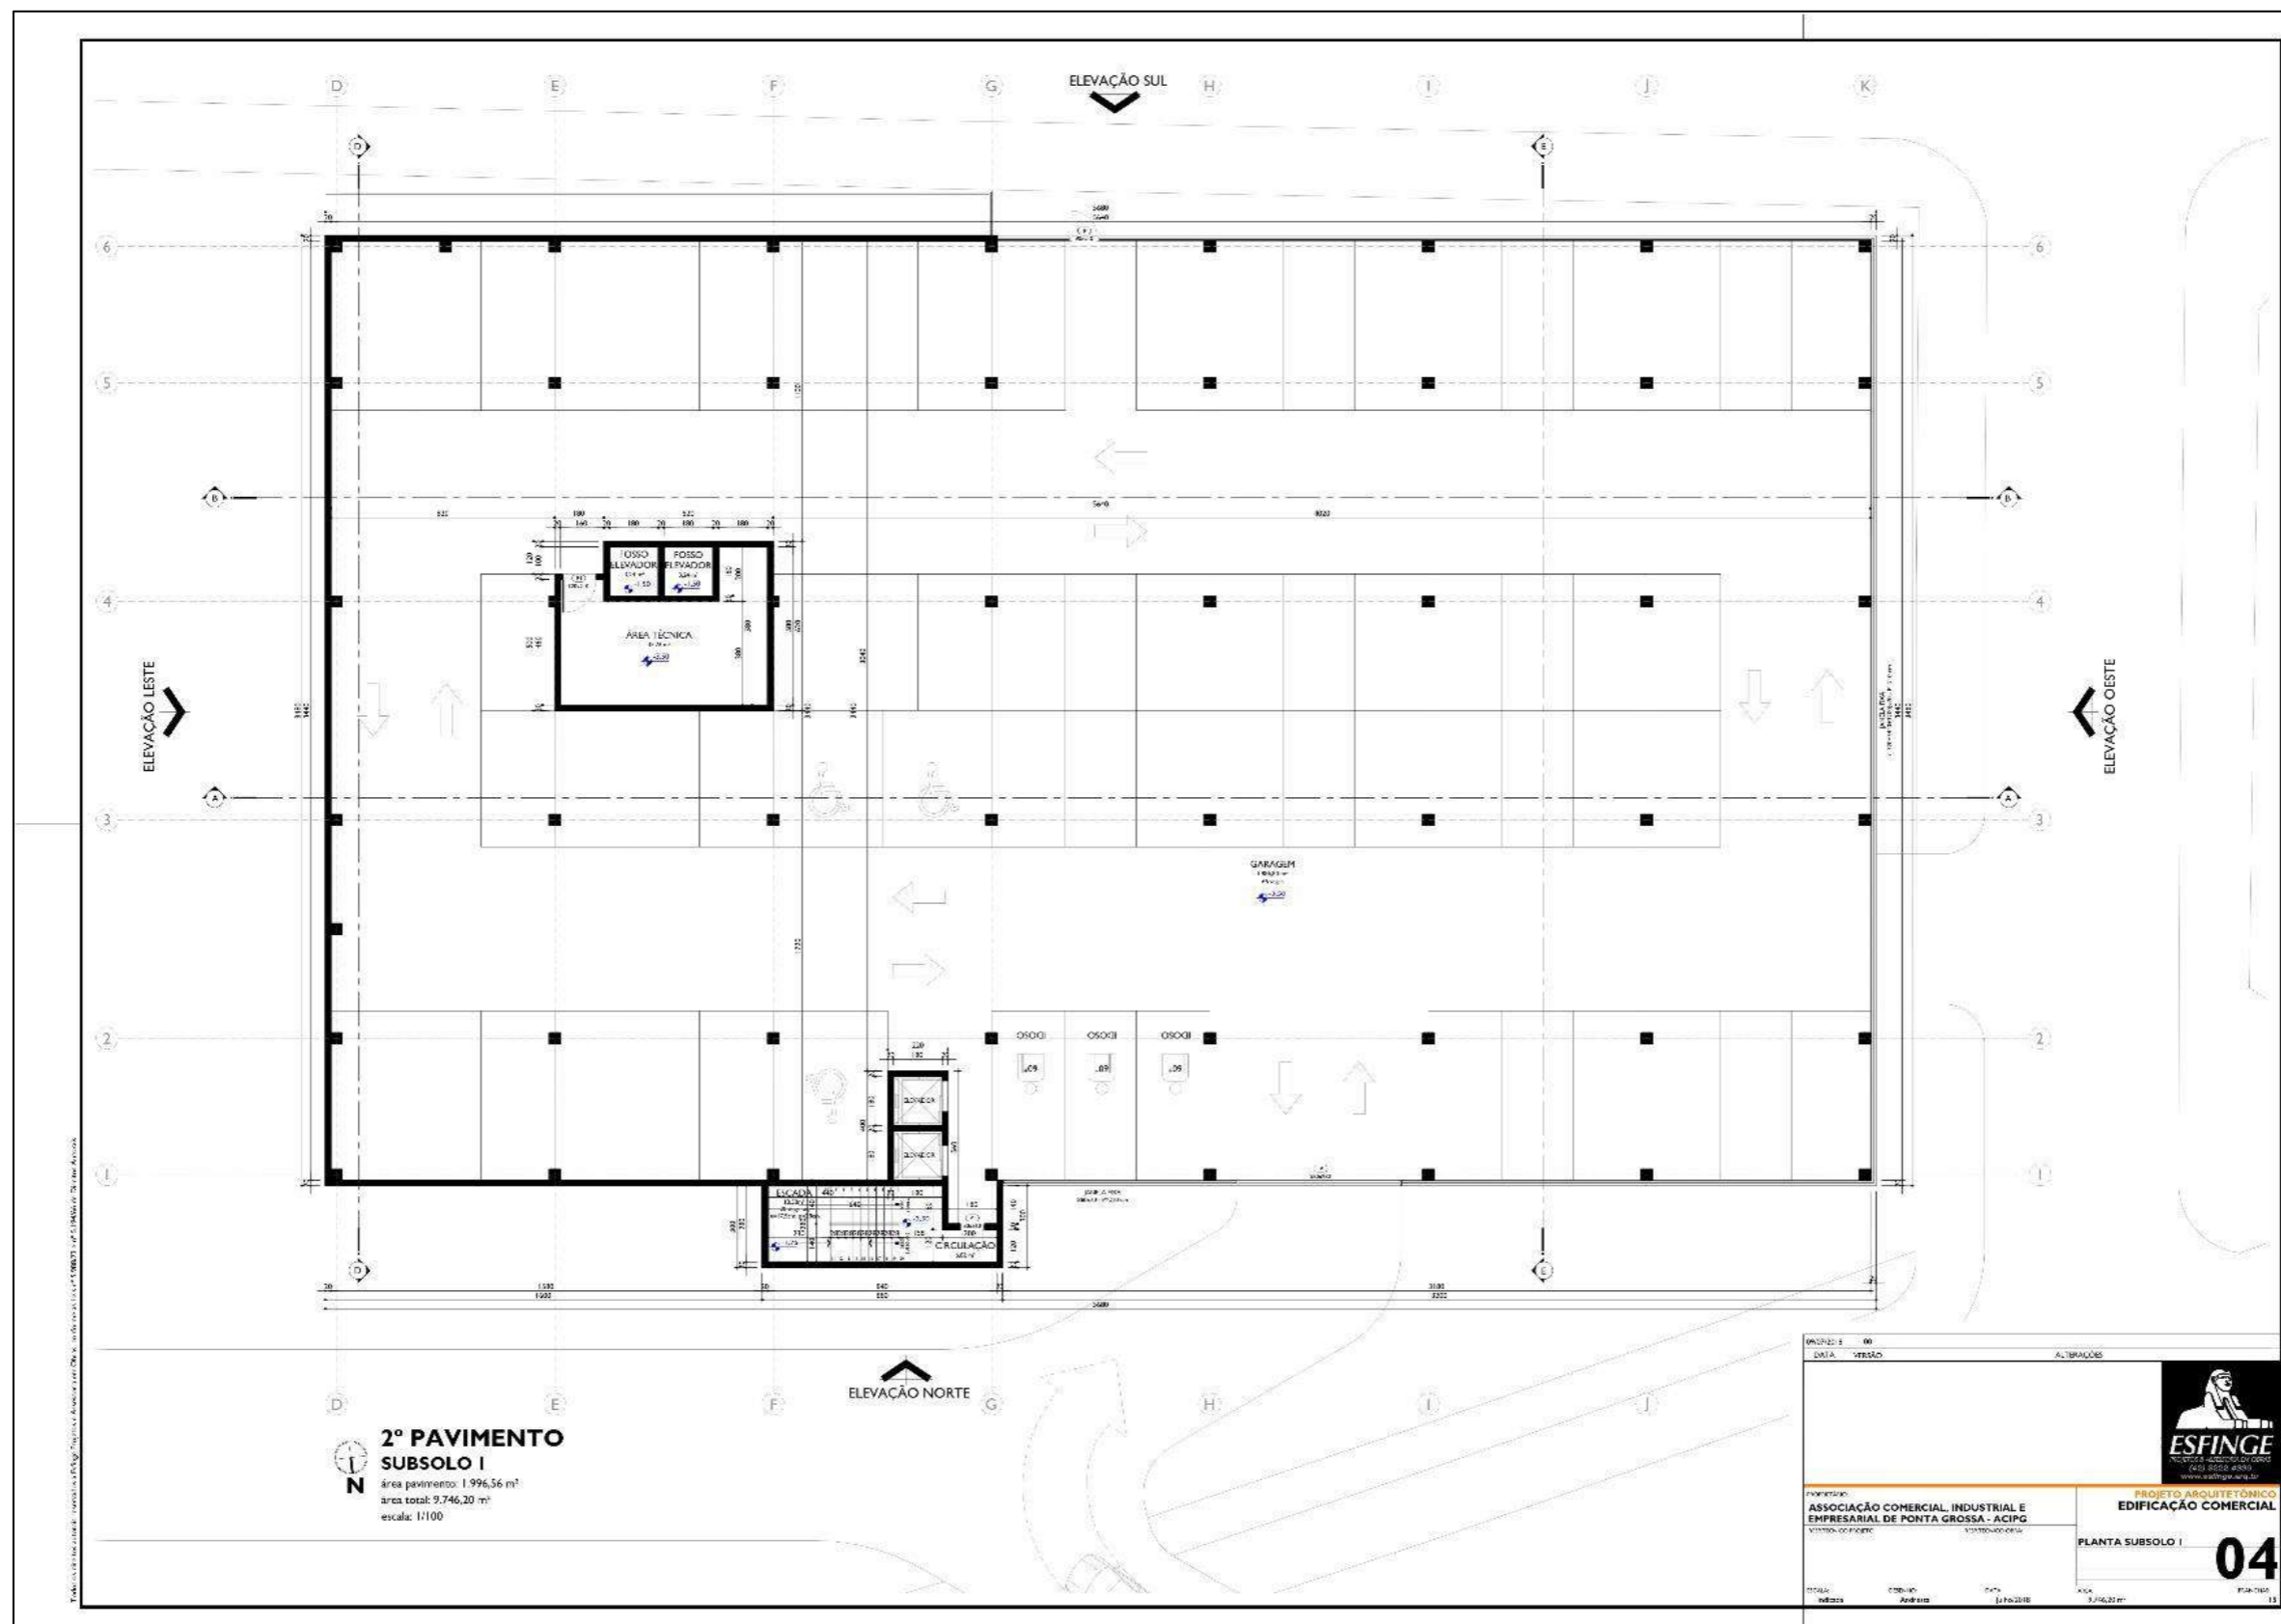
Planta subsolo 1. Fonte: Esfinge Arquitetura e Engenharia (2018).
